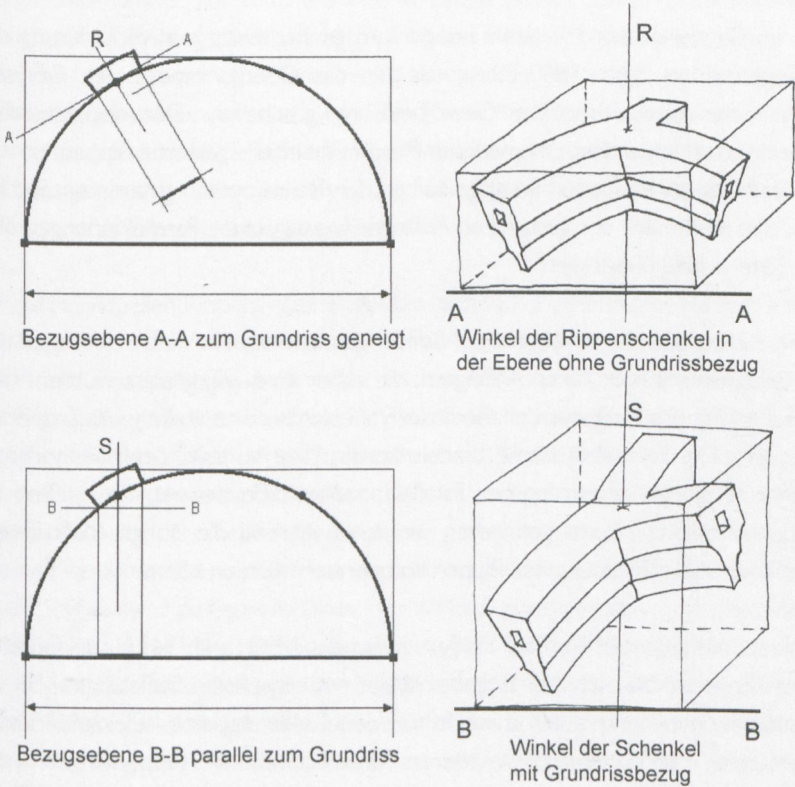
Entwurf und Fertigung der Werkstücke für Kreuzpunkte aus dem Grundriß (Zeichnung: Bürger)
